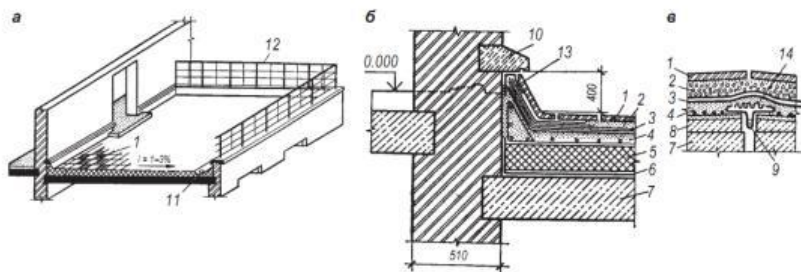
Експлуатаційні дахи: а – схема даху; б – примикання до стіни; в – деформаційний шов у холодному покритті; 1 – залізобетонні плити; 2 – дренажний шар із гравію; 3 – гідроізоляційний килим; 4 – залізобетонна стяжка; 5 – утеплювач; 6 – пароізоляція; 7 – несуча конструкція; 8 – шар бетону з похилом; 9 – компенсатор із листової оцинкованої сталі; 10 – бортовий камінь; 11 – жолоб; 12 – огороження; 13 – фартух з оцинкованої дахової сталі; 14 – антисептоване ключчя
